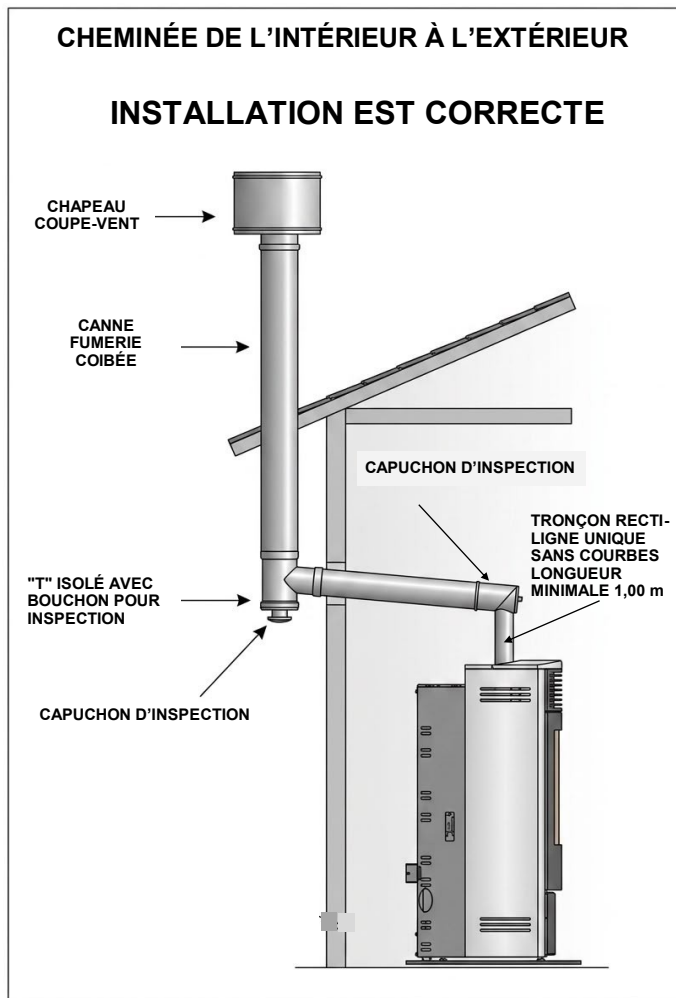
D – Installation du conduit intérieur - extérieur.
